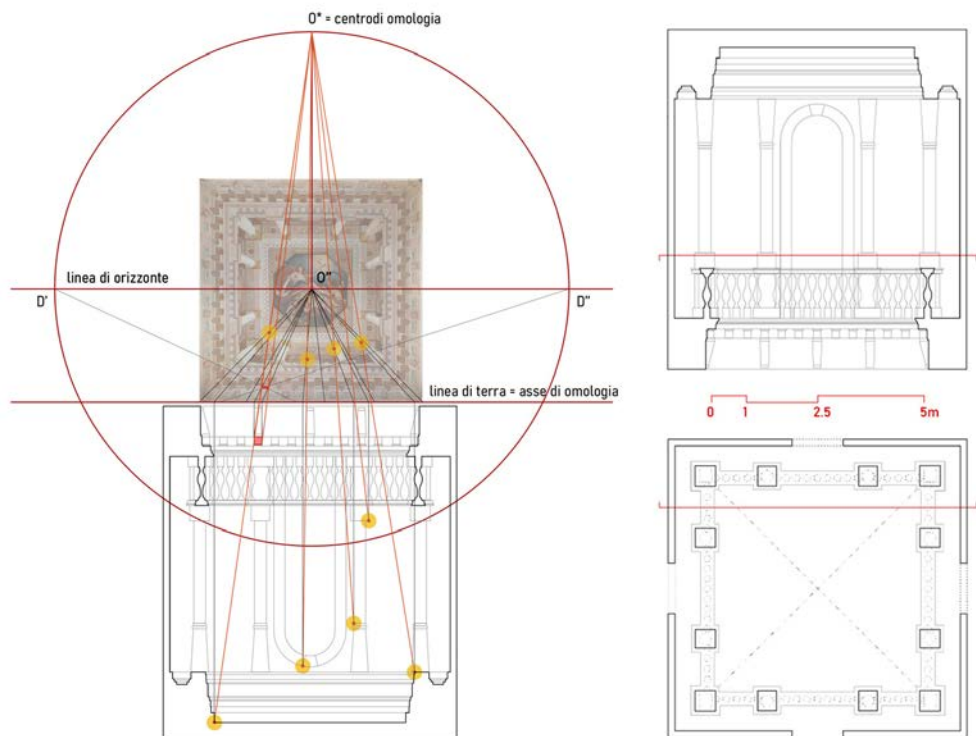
Restituzione prospettica di pianta e sezione dello spazio dipinto.
